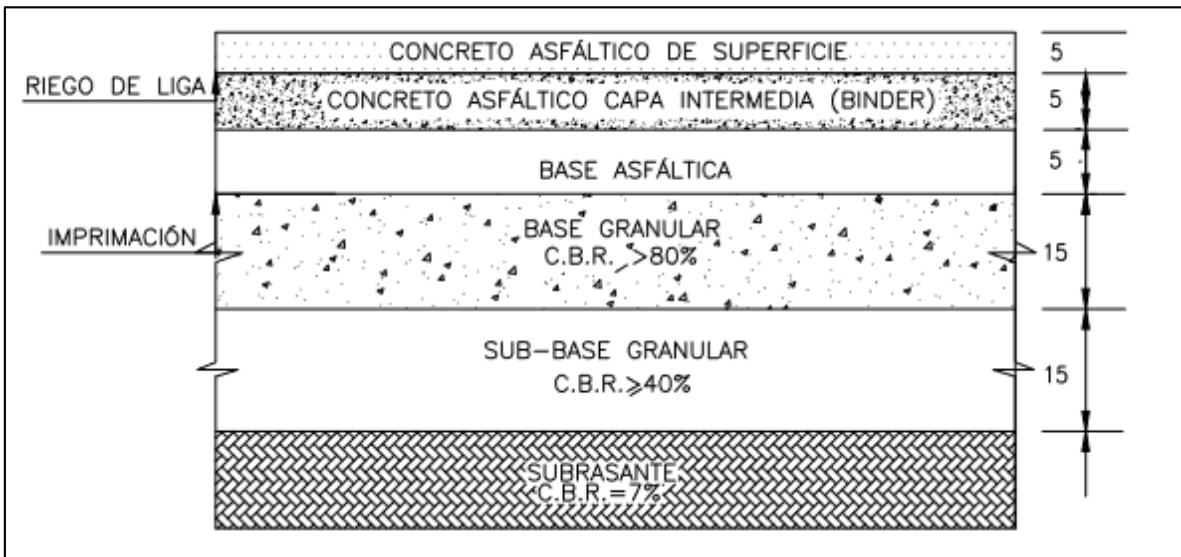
Perfil longitudinal del paquete estructural de la Ruta F-50.
